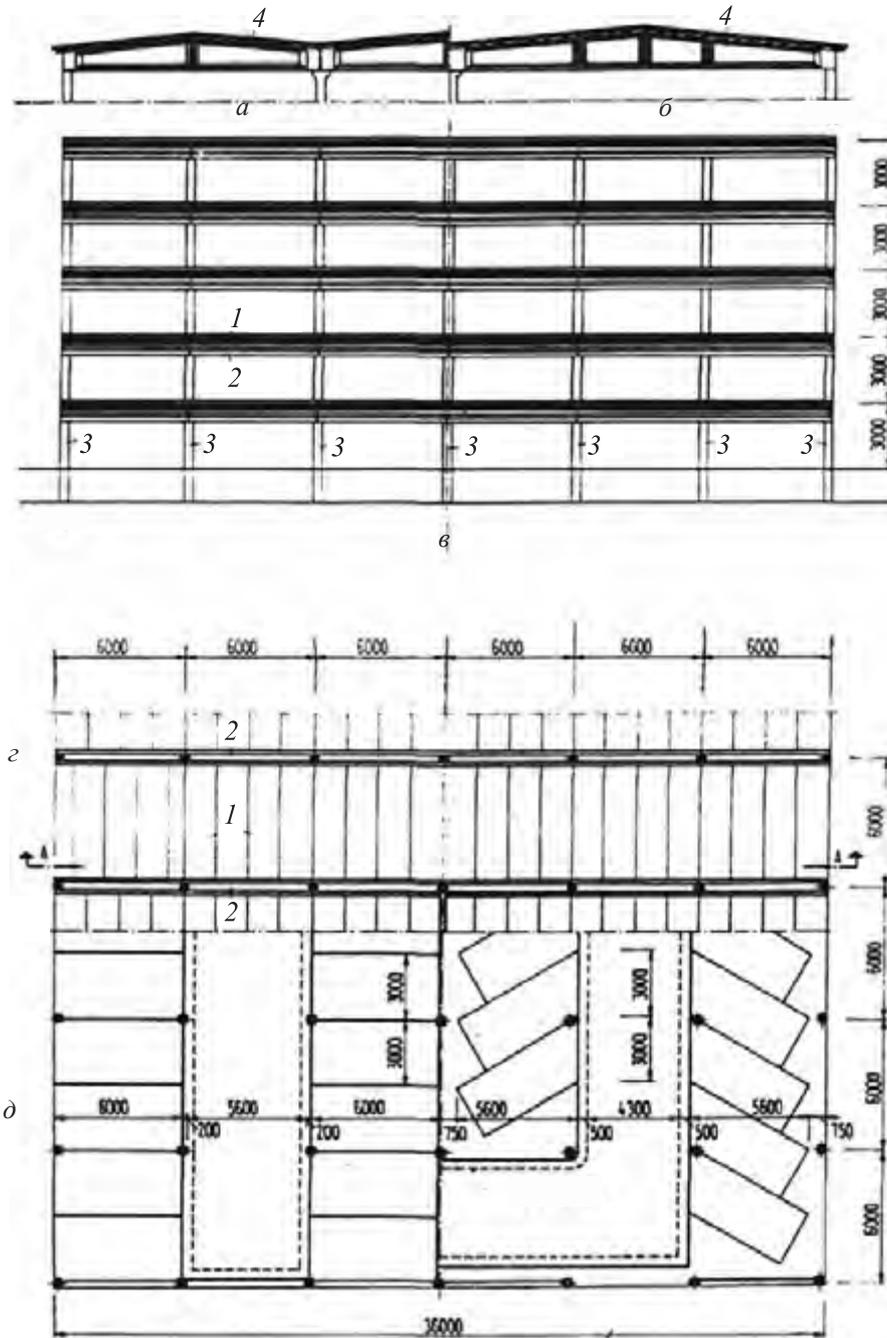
Возможные варианты прямоугольной и косоугольной расстановки автомобилей относительно оси проезда при сетке колонн 6000×6000 мм. Высота этажа 3000 мм: *a* — вариант скатных кровель пролетом 12000 мм; *б* — вариант скатных кровель пролетом 18000 мм; *в* — разрез; *г* — план раскладки плит перекрытия и несущих балок; *д* — варианты расстановки автомобилей; 1 — плита перекрытия, 250 мм; 2 — балка 400×700 мм; 3 — колонна 400×400 мм; 4 — кровля
